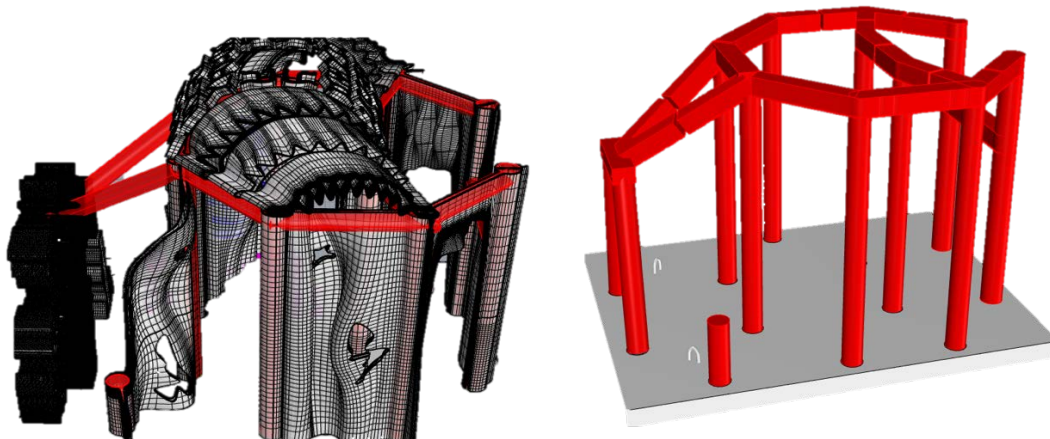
Illustrations d'une structure mixte béton armé/béton 3D avec en rouge les poteaux et poutres en béton armé coffrés par les éléments imprimés en 3D en noir (RECIF LAB–2021)
